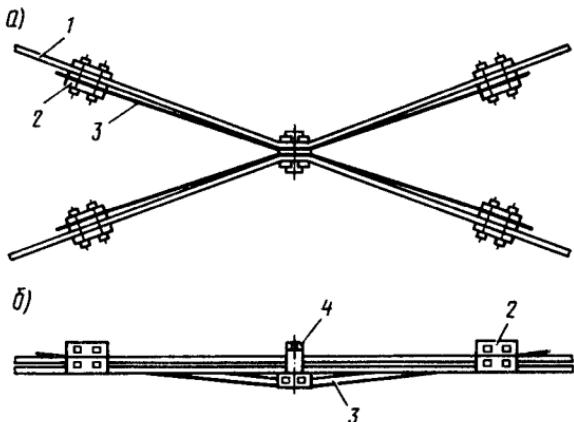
Пересечение трамвайных проводов с дополнительными проводами:
